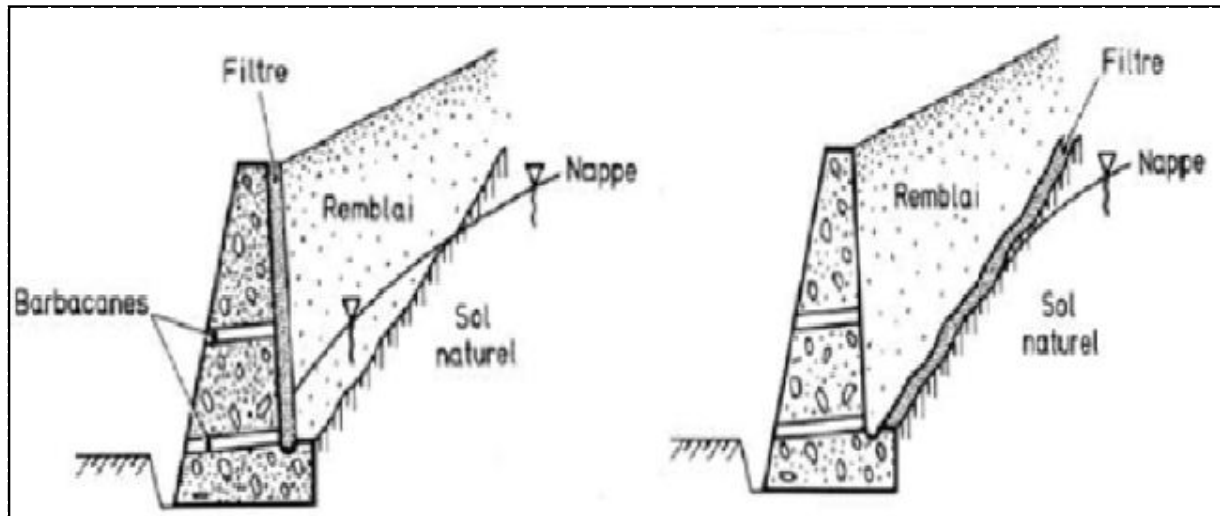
V : Le dispositif de drainage des murs de soutènements.
